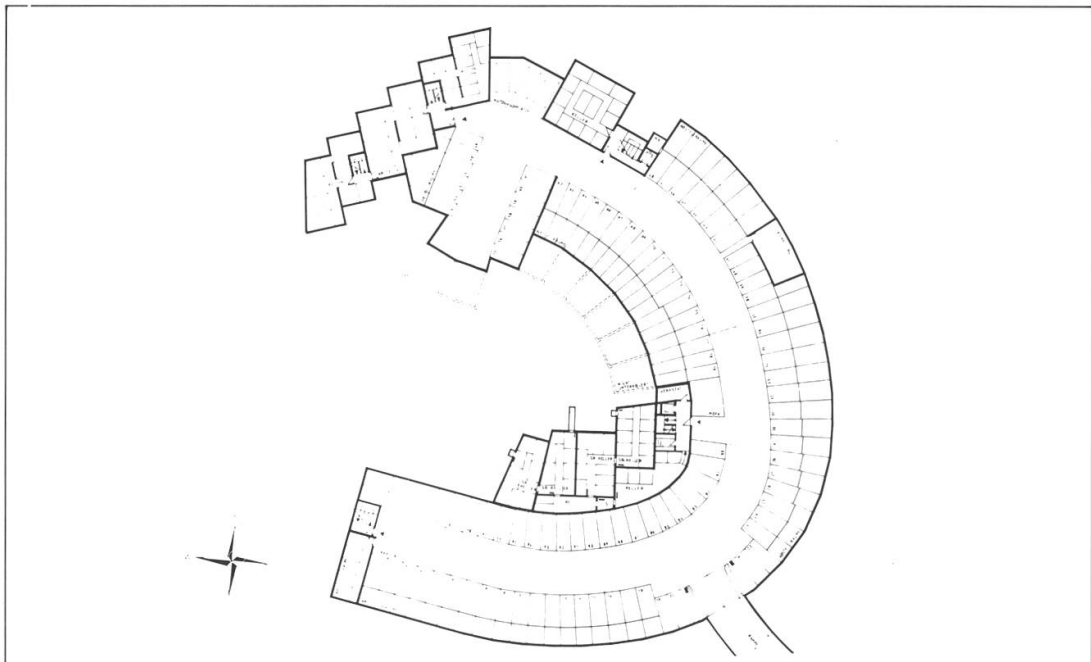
Grundriß Untergeschoß Vorprojekt 1:200
